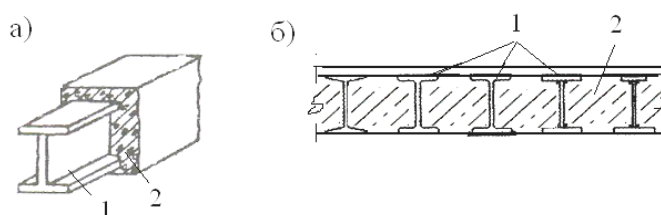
Усиление металлических балок устройством железобетонной обоймы (а) или междубалочного заполнения монолитным бетоном (б):
